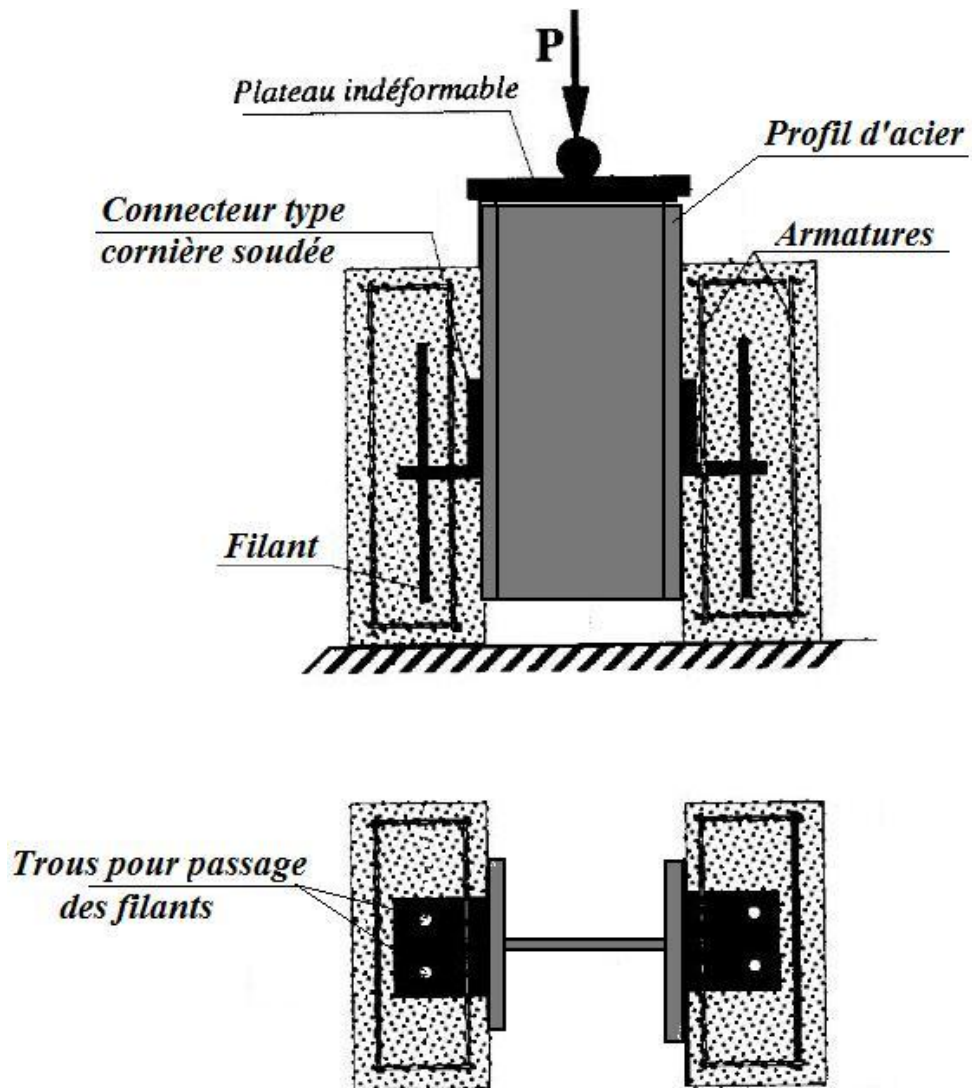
Corps d'essai Push-Out sur un connecteur type cornière avec filant. [18]
